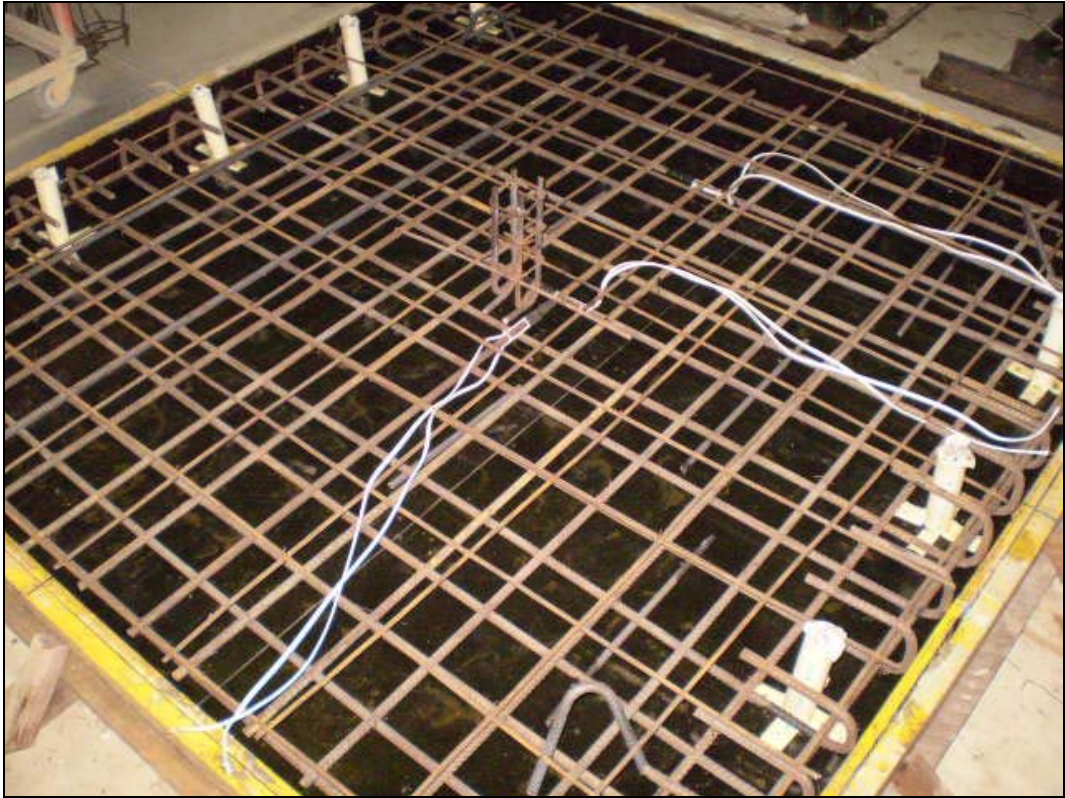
Instalação de extensômetros nas armaduras das lajes com pilares de índice 1 e 7
